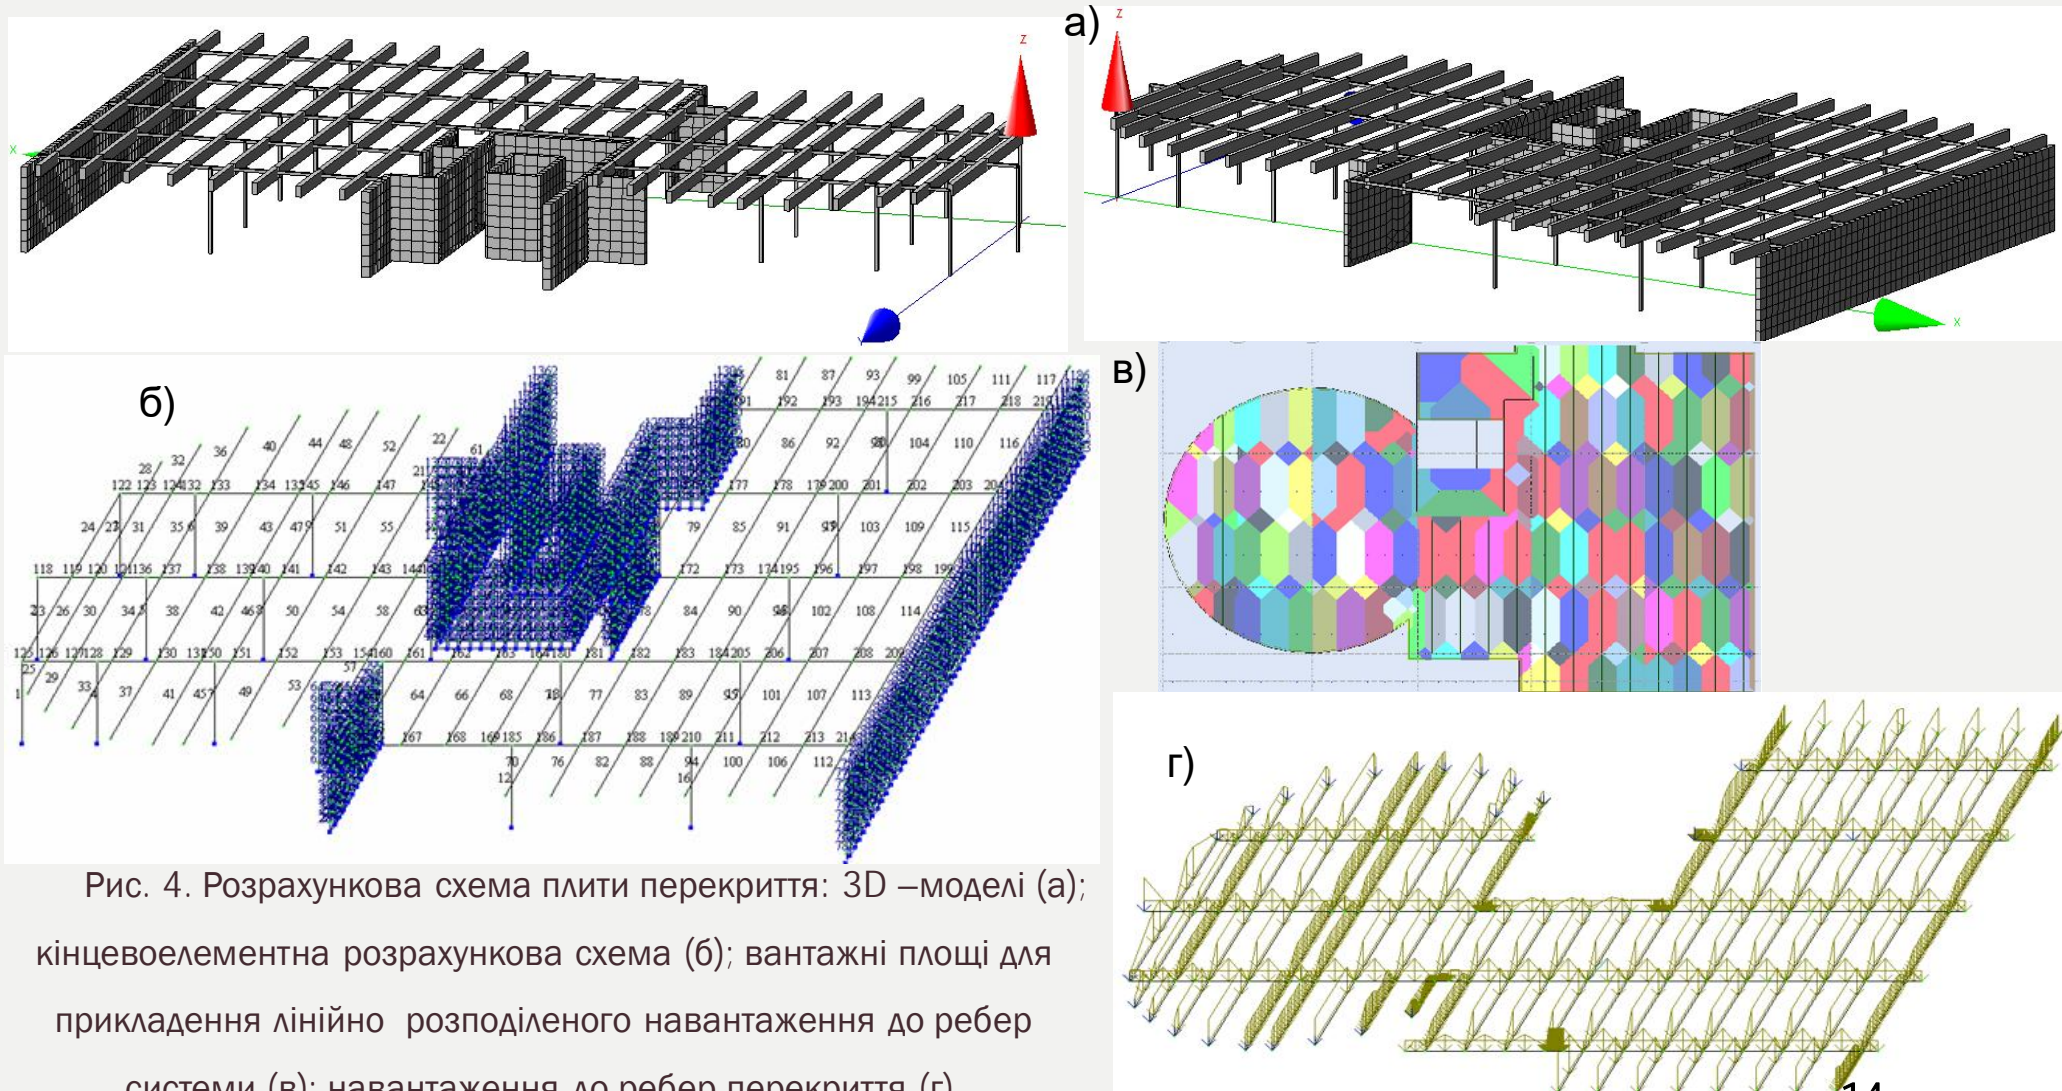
Розрахункова схема плити перекриття: 3D – моделі (а); кінцевоелементна розрахункова схема (б); вантажні площі для прикладення лінійно розподіленого навантаження до ребер системи (в); навантаження до ребер перекриття (г).
